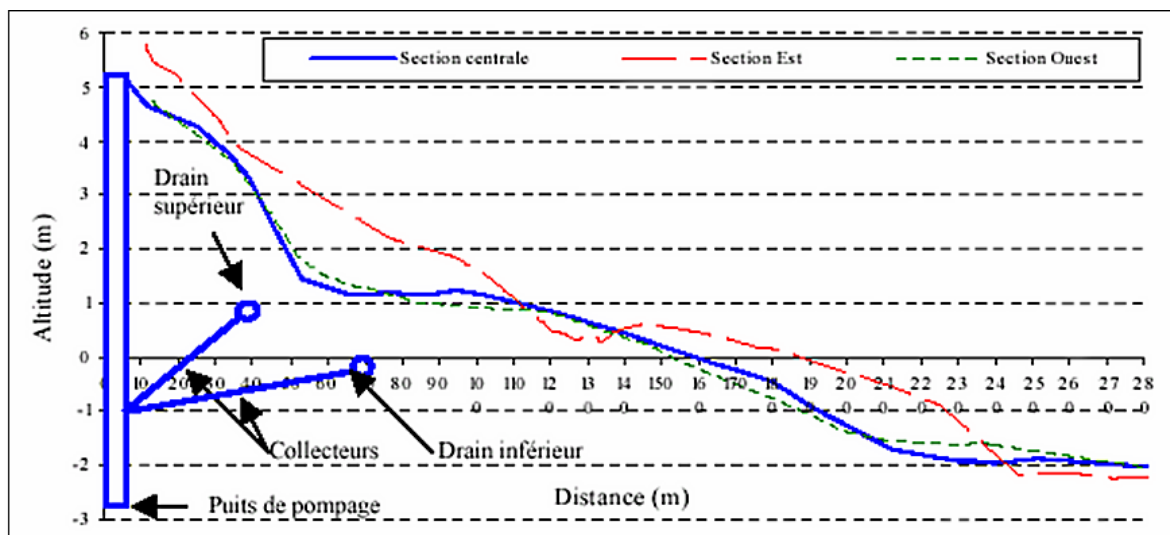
vue en coupe des installations du dispositif de drainage de plage et profils moyens des sections ouest, est et centrale (source : J.M. COUTON)
